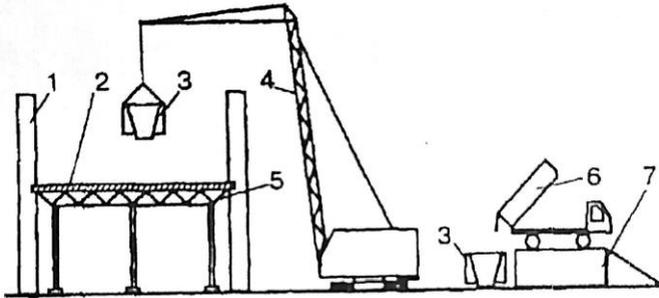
Схема подачи бетонной смеси с помощью самоходного стрелового крана.
